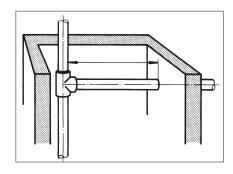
Emplazamiento más idóneo en el canal de tubería
